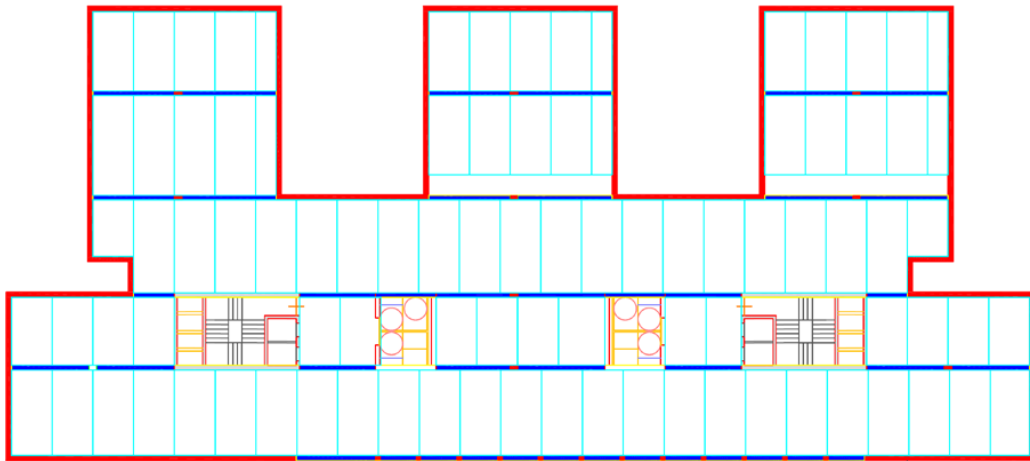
Planta mostrando la dirección de los paneles que forman el forjado.
